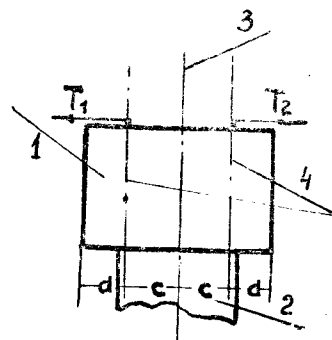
Схема работы насадки свайной опоры на горизонтальные усилия:
